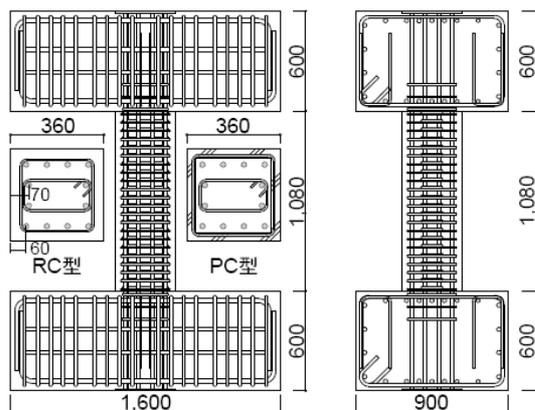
試體配筋詳圖 (資料來源：文獻 4)
